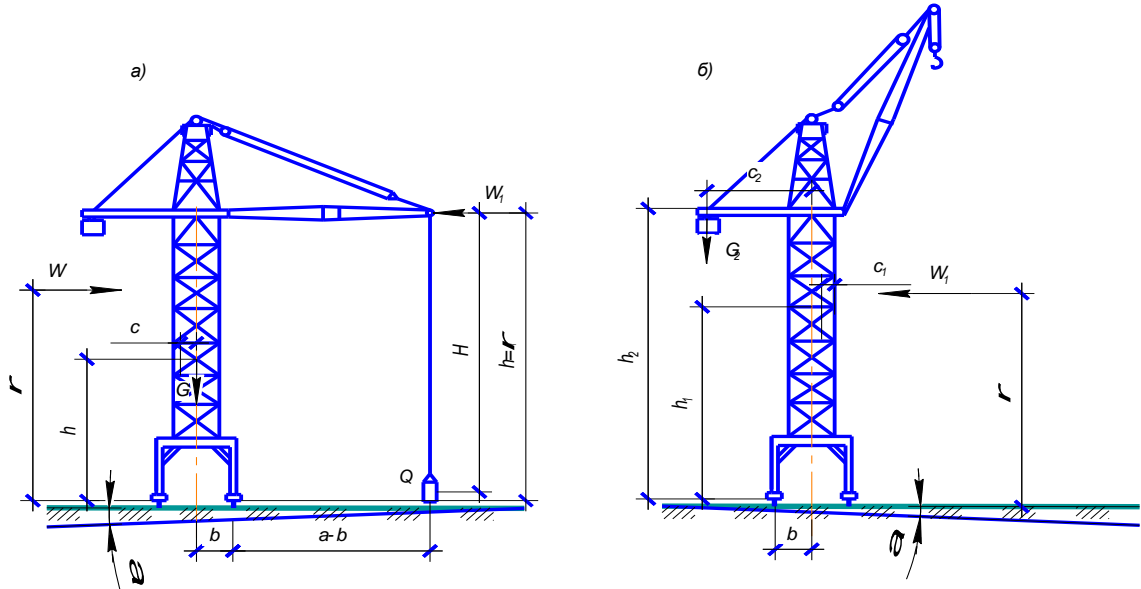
Расчётная схема устойчивости башенного крана с грузом (а), без груза (б)
